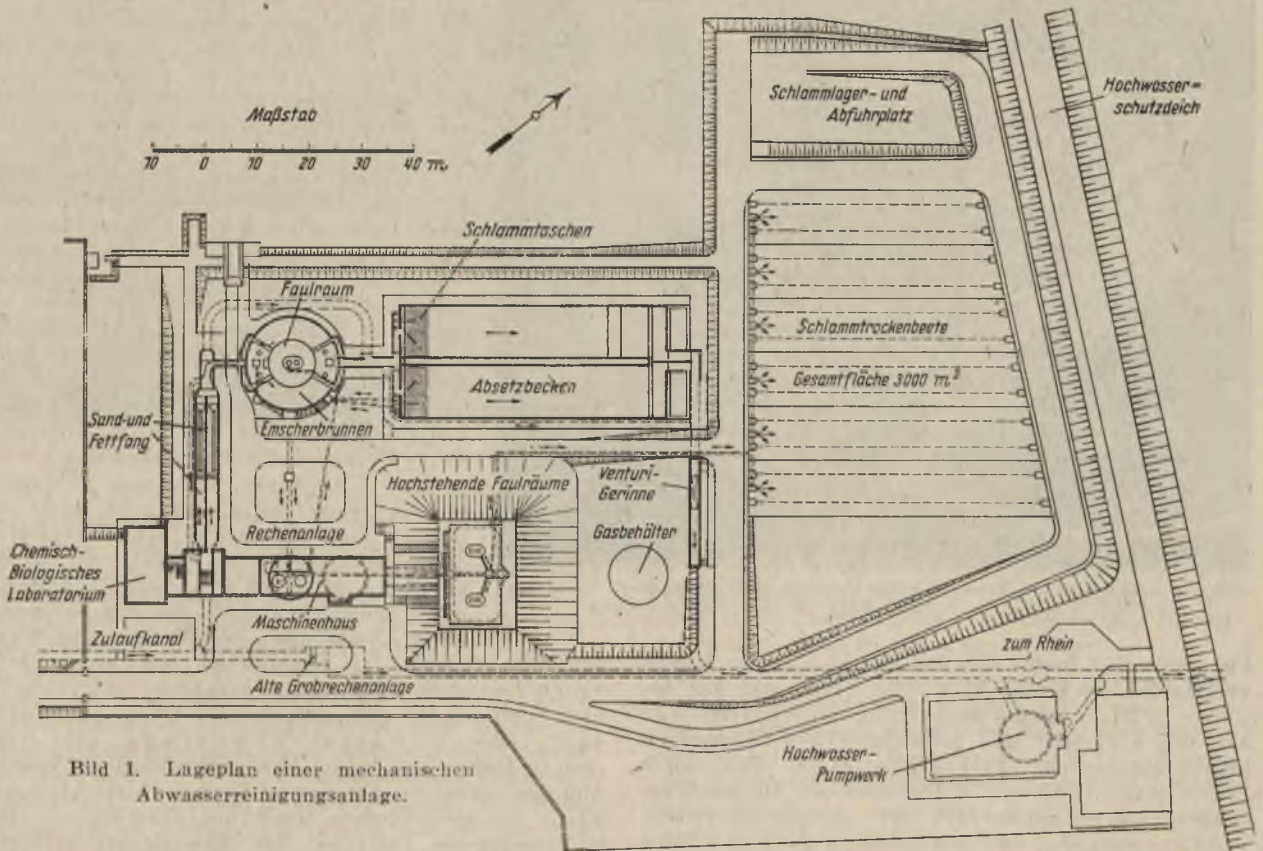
Lageplan einer mechanischen Abwasserreinigungsanlage.
